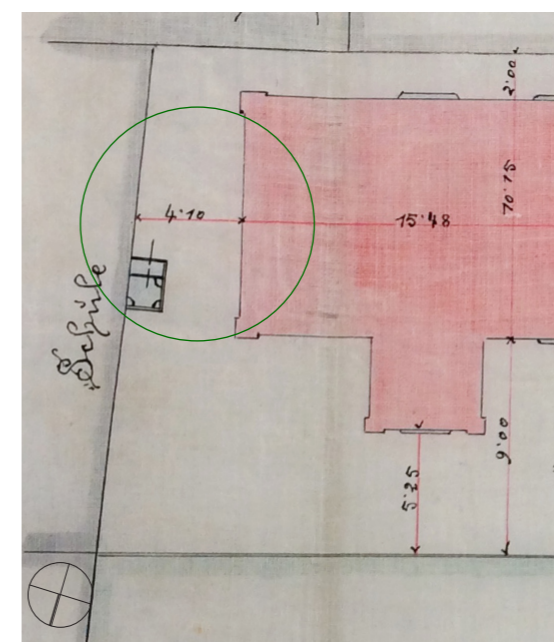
Lageplan Einreichung (1884) [ma37]
